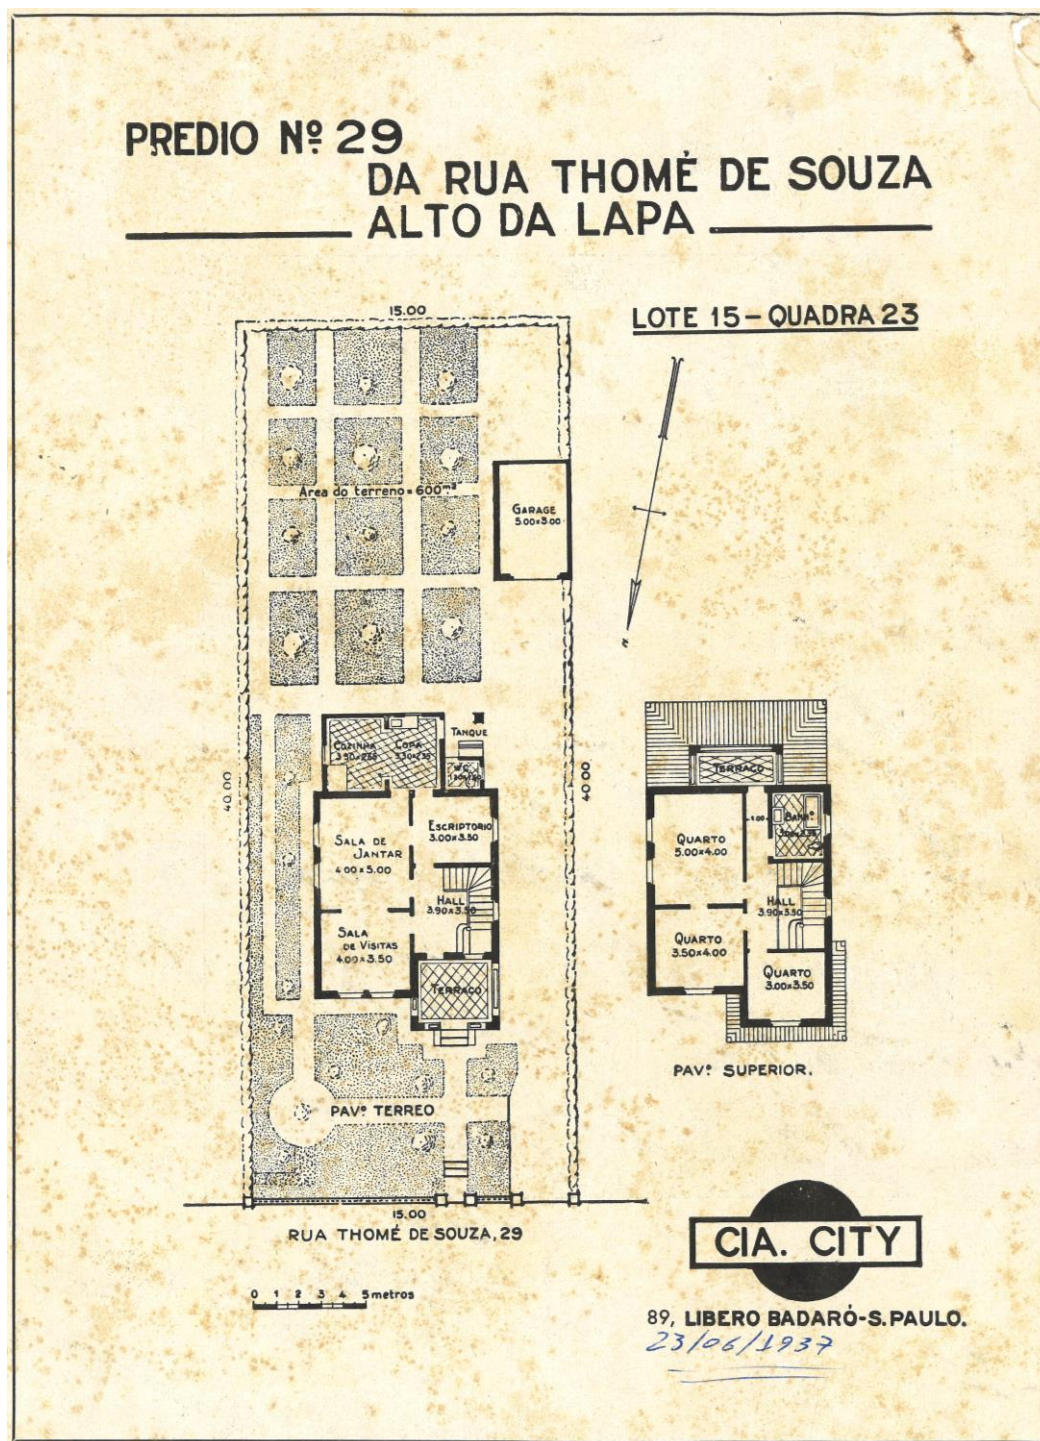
Planta de uma propriedade da Cia City. Ano 1937. Fonte: Acervo Cia City
